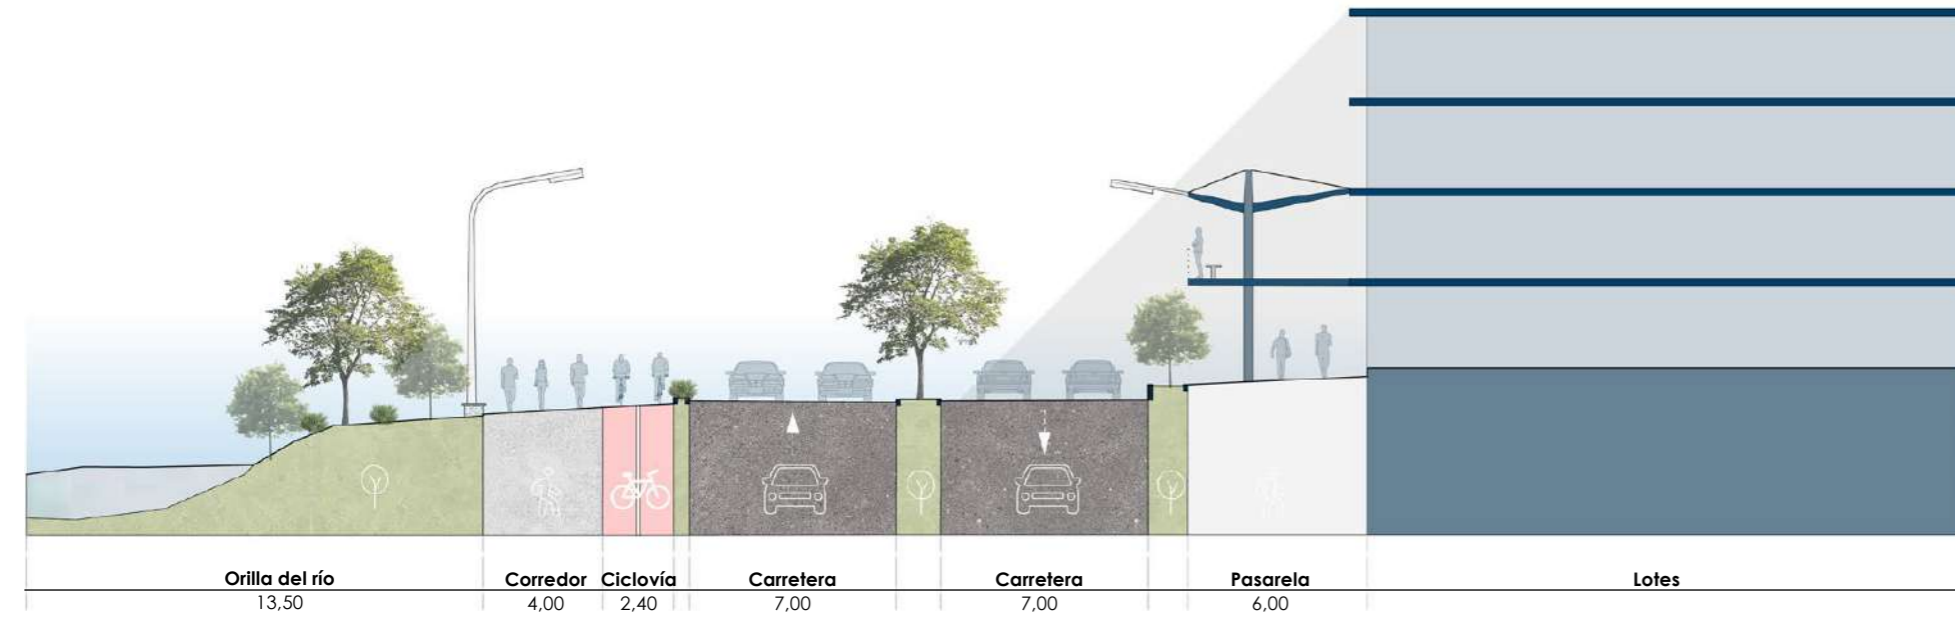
Sección vial (Tramo 10-15m). Fuente: Autoría propia (2026)
